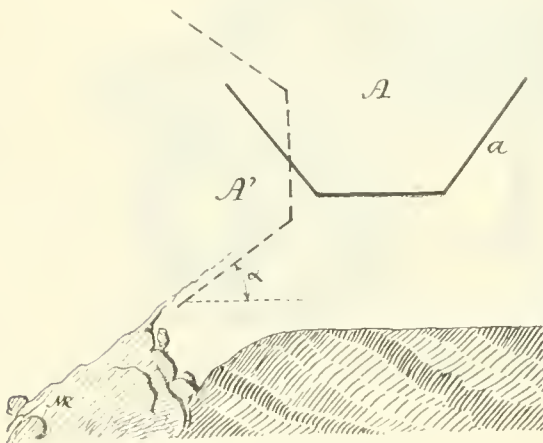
Coupe transversale du coffre d'une brouette du type anglais.
